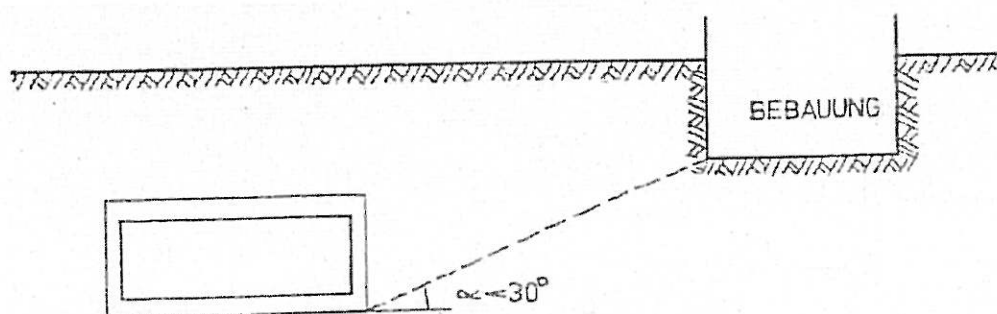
Lage der Bebauung, für die kein Erddruck aus Bebauung anzunehmen ist
